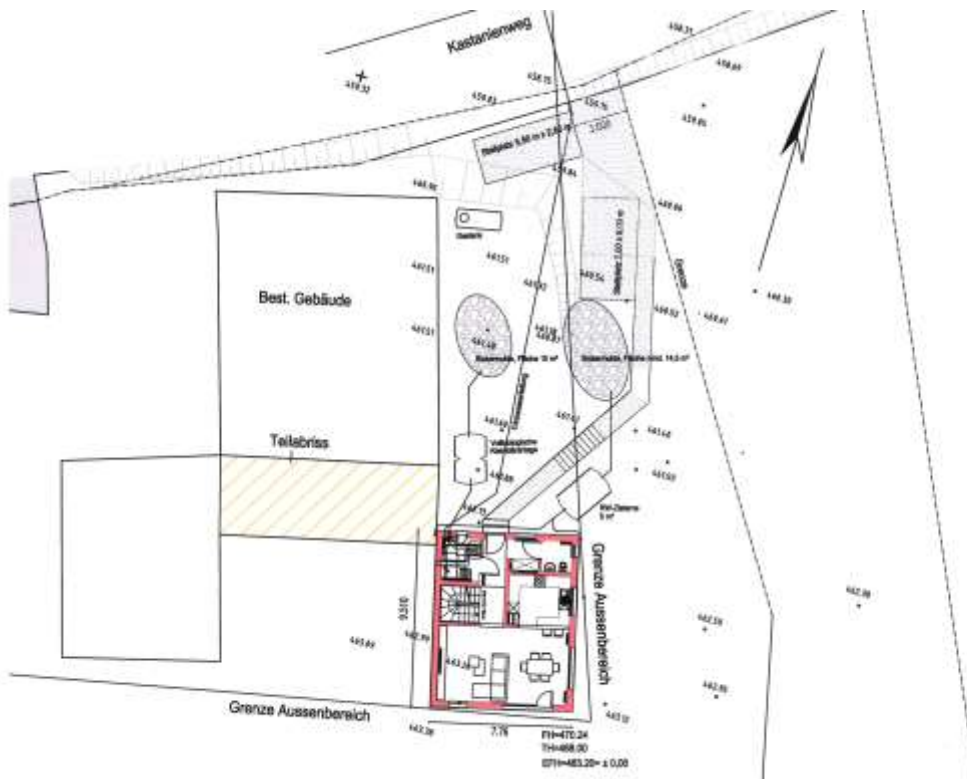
Ausschnitt Lageplan zum Bauantrag vom 10.08.2022
